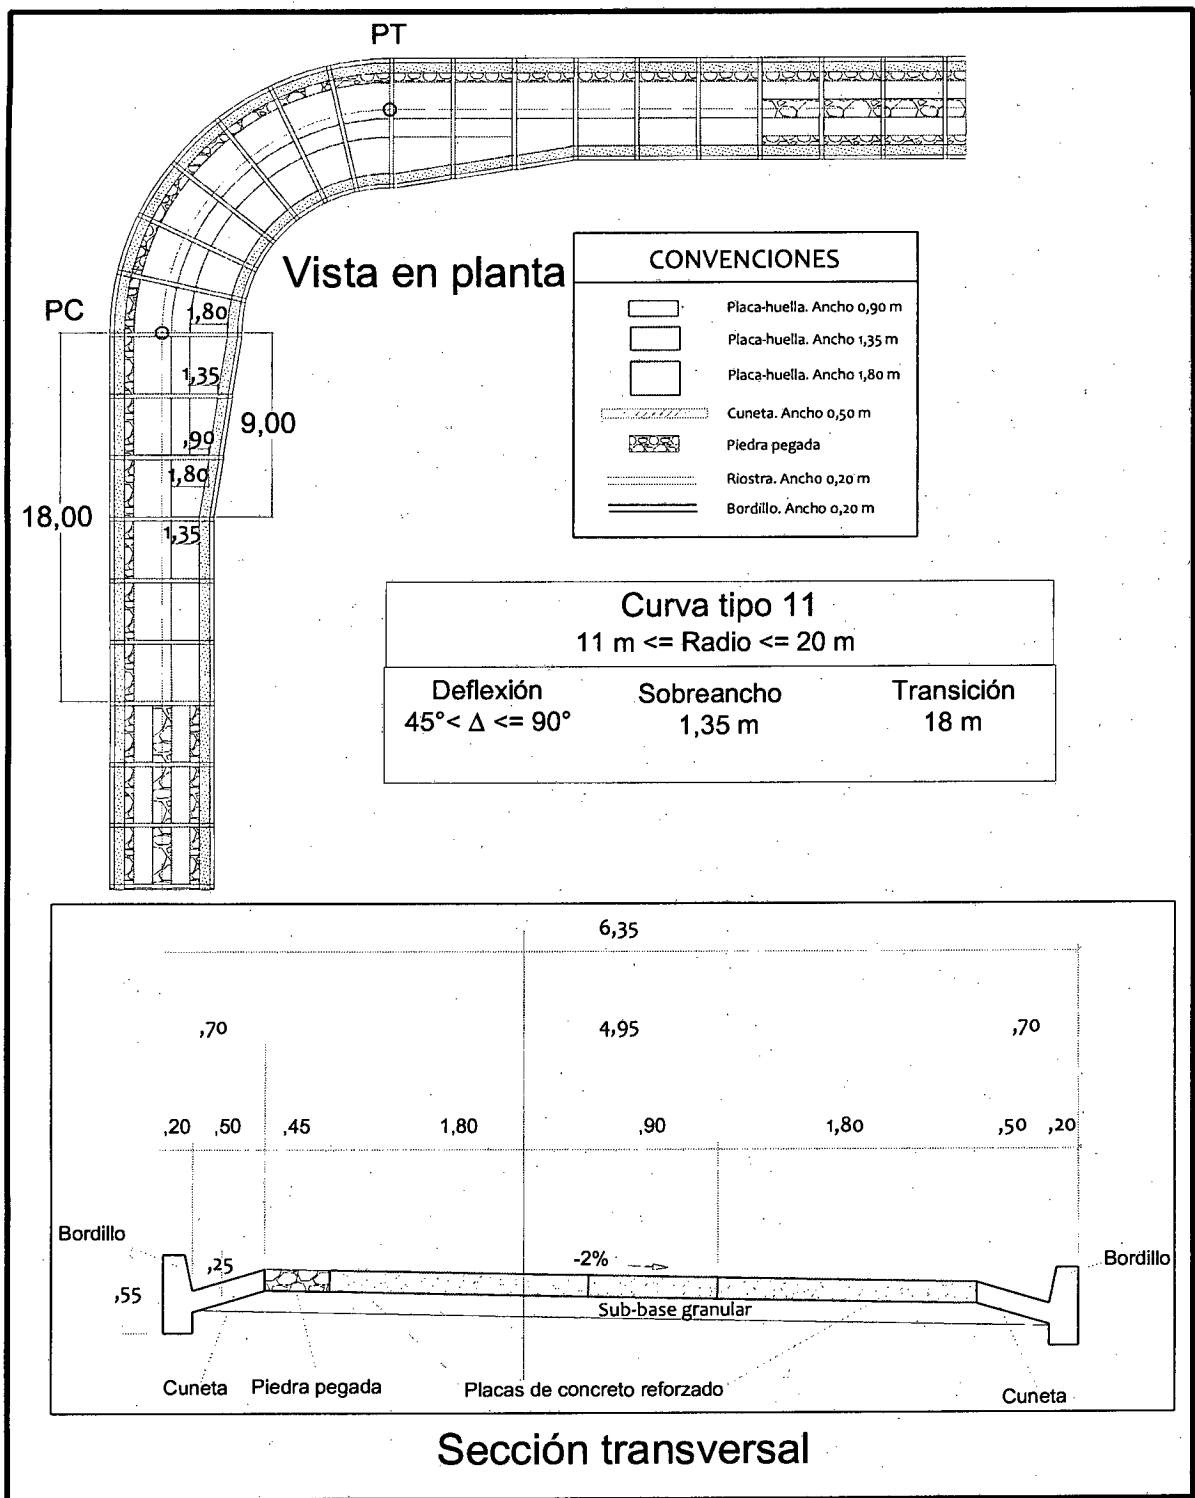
Vista en planta y perfil de la sección transversal en curvas TIPO 11 45 < Δ ≤ 90° y 11 m ≤ Rc ≤ 20 m
